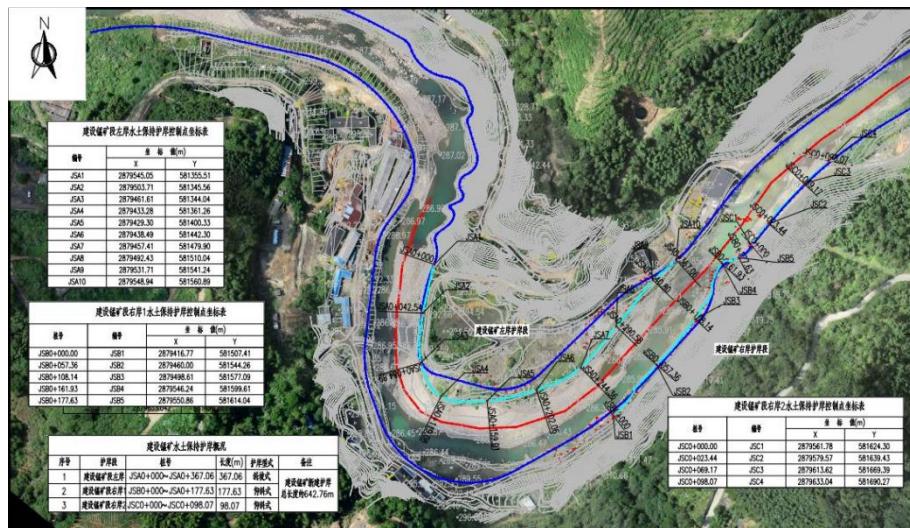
文江溪建爱锰矿段水土保持护岸平面布置图
